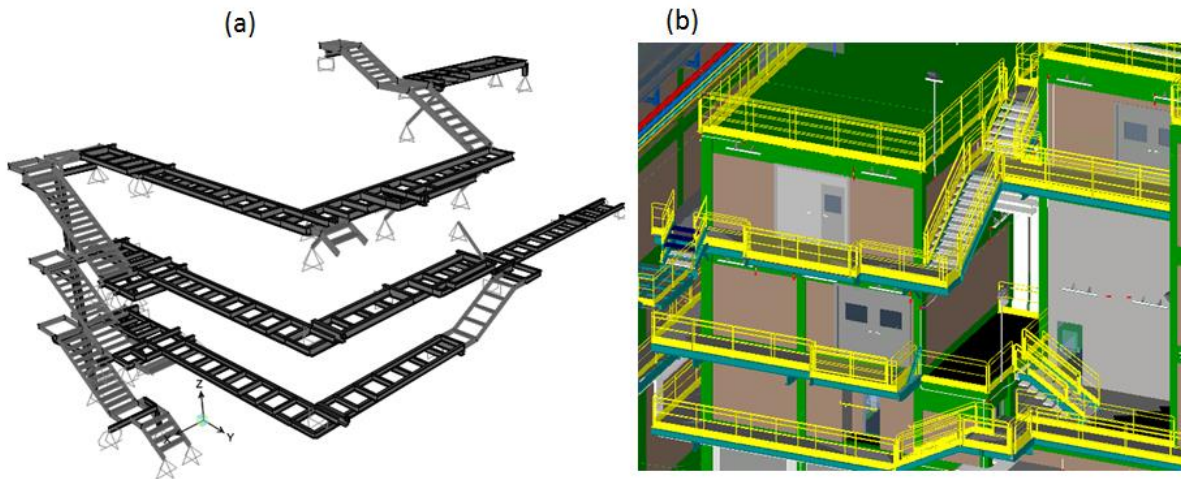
Estruturas Metálicas de Escadas e Passarelas moldadas na ferramenta SAP2000 (a) e compatibilizada ao modelo Arquitetônico no Revit Architecture (b)
